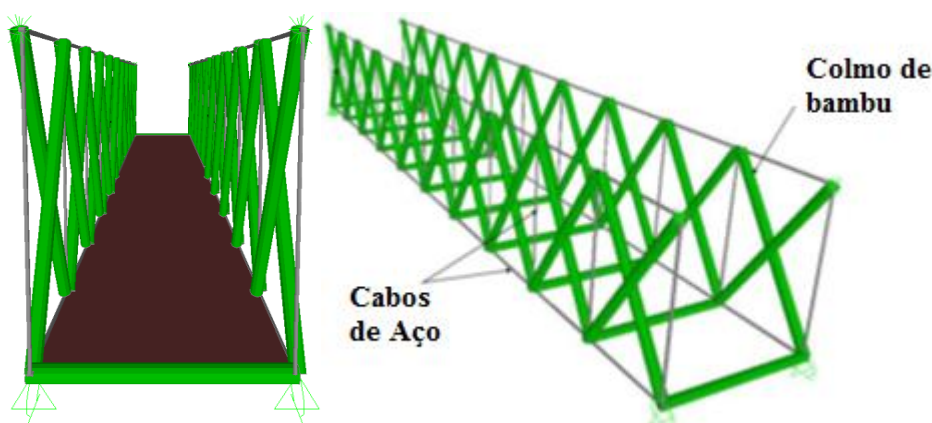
Ponte dobrável de bambu: a) vista frontal, b) vista tridimensional.
